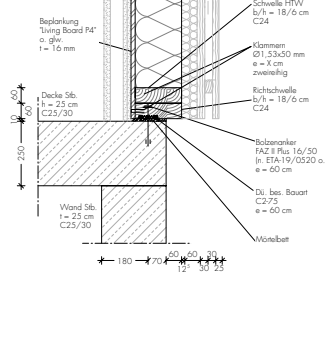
Schubanschluss Deckenscheibe an HTW - E4
